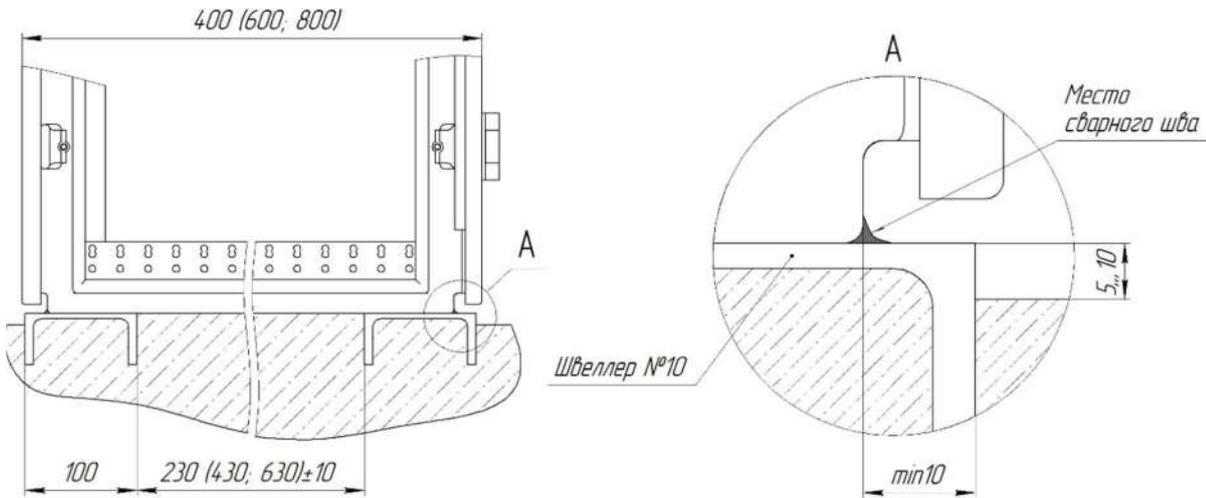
Крепление Ш8300 к закладным элементам при помощи сварки
